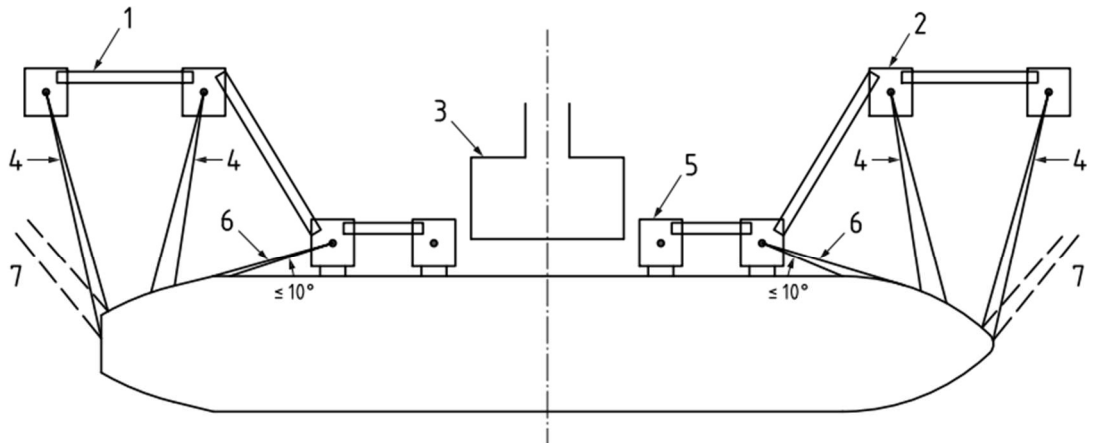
Layout de amarração – estruturas discretas – ROM 0.2-90
